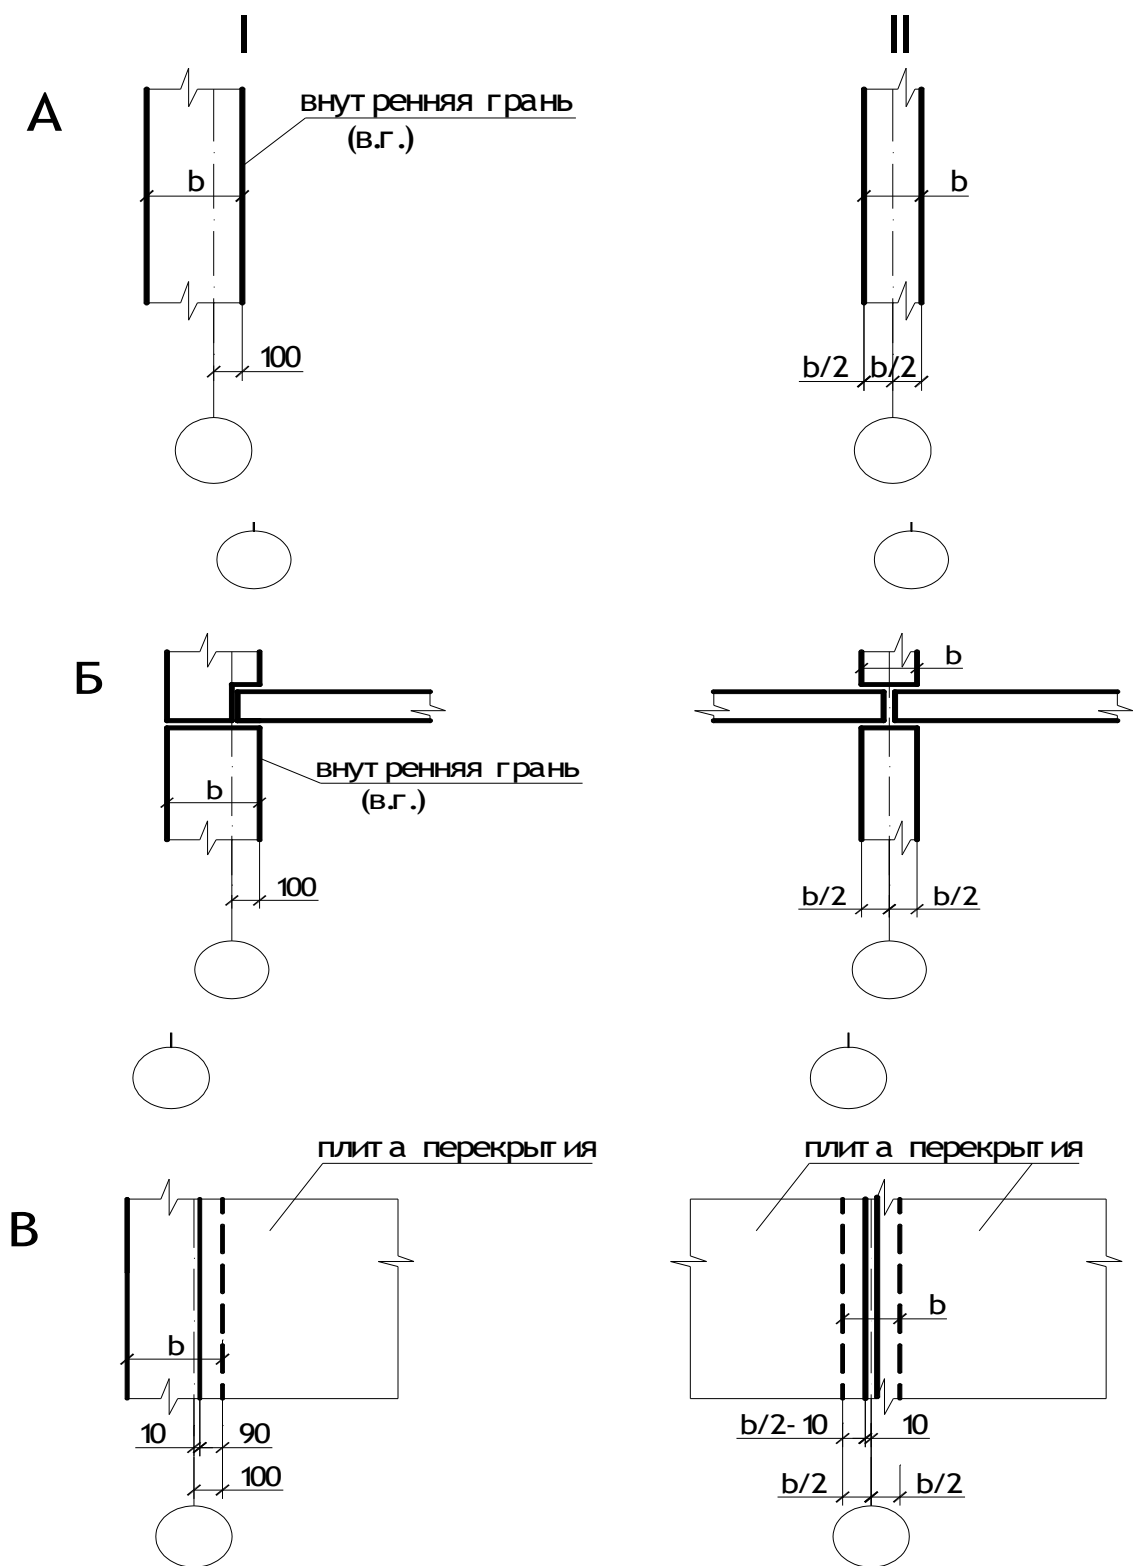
Привязки конструкций крупнопанельных зданий к разбивочным осям: А – на плане, Б – на разрезе, В – на плане перекрытия; I – несущая наружная стена, II – внутренняя стена
